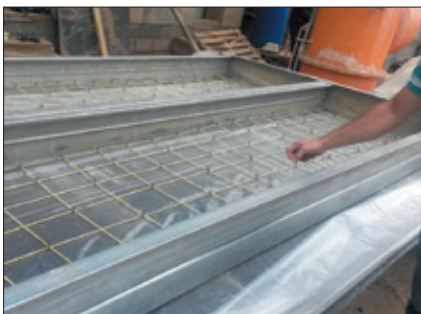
Каркас плиты перекрытия из ЛСТК перед заливкой пеногипса
